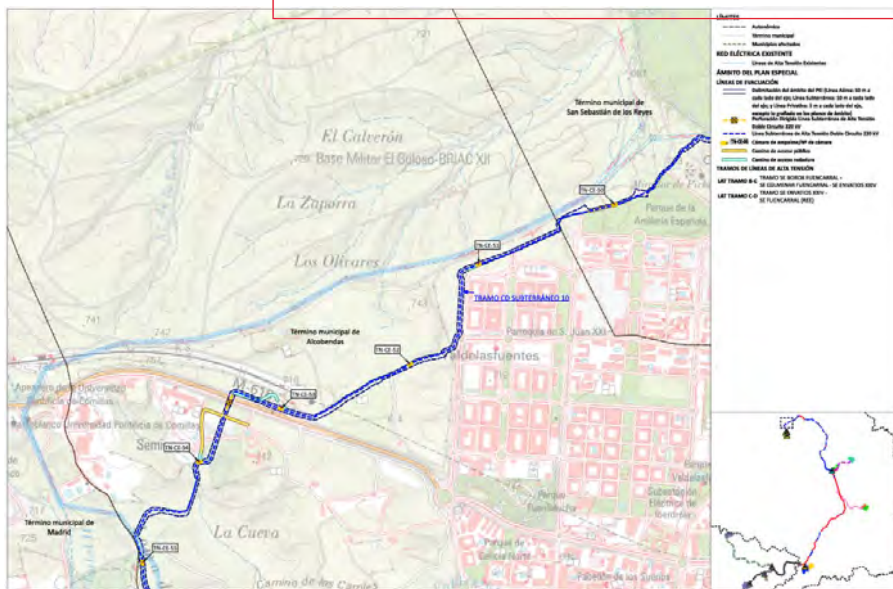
Plano de Ordenación O2.5.13. Planta por tramos. LASAT Promotores Nudo Fuencarral Tramo C-D
